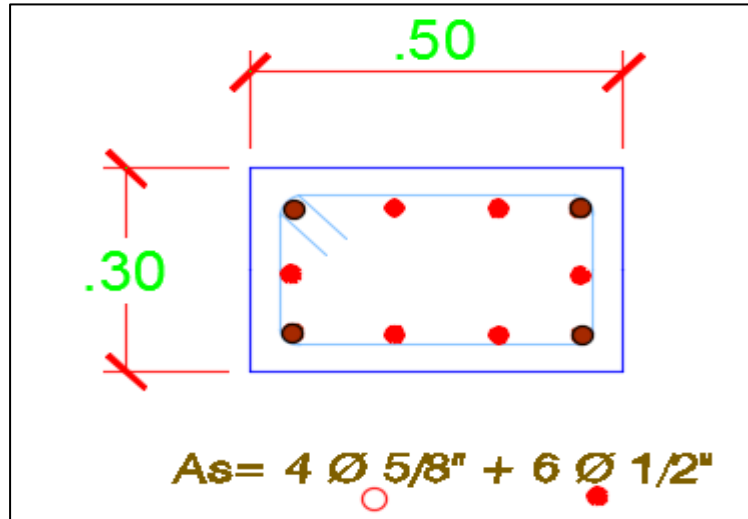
Sección Transversal Columna C-2 x-x. Fuente: Elaboración propia.
